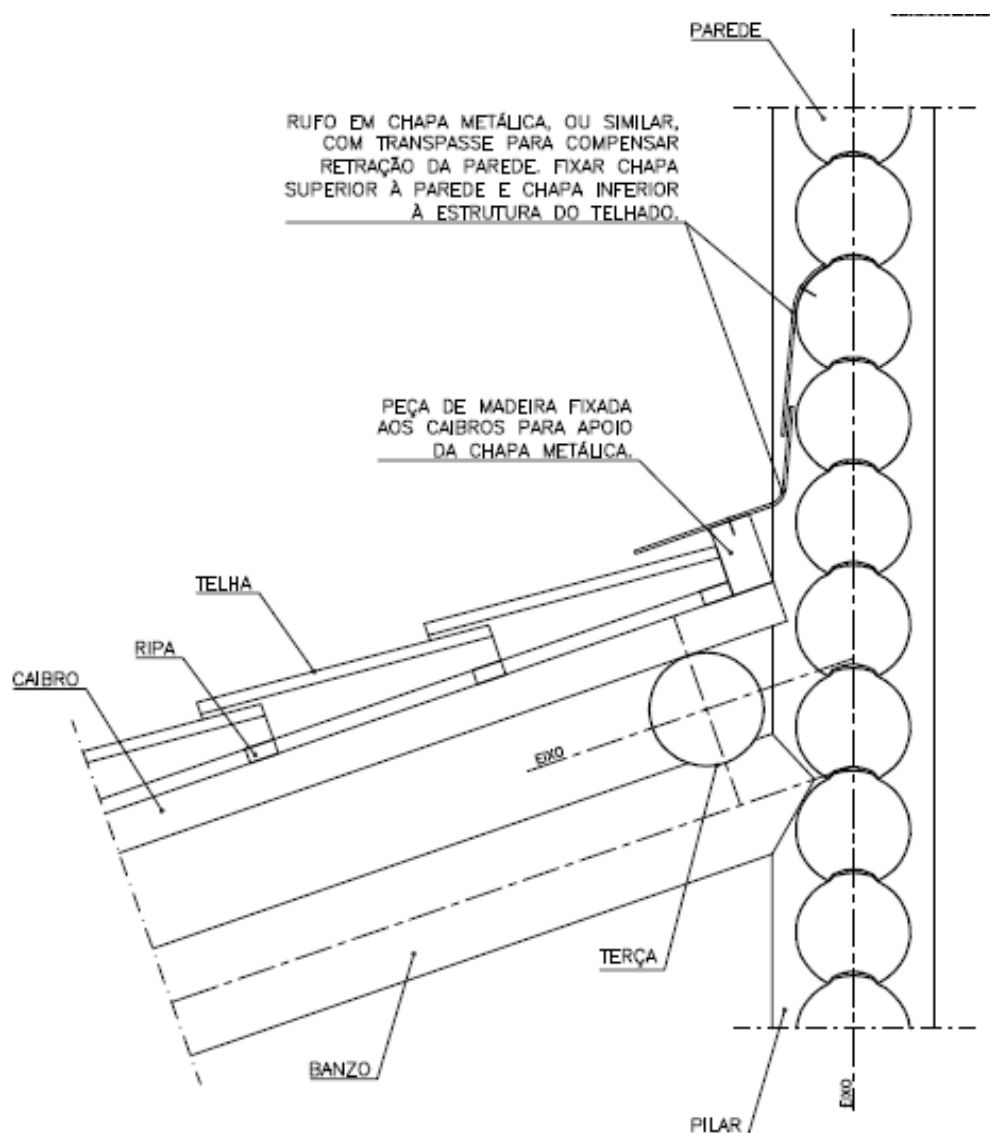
Detalhe de execução do rufo. Projeto cedido pela EMPRESA B.
